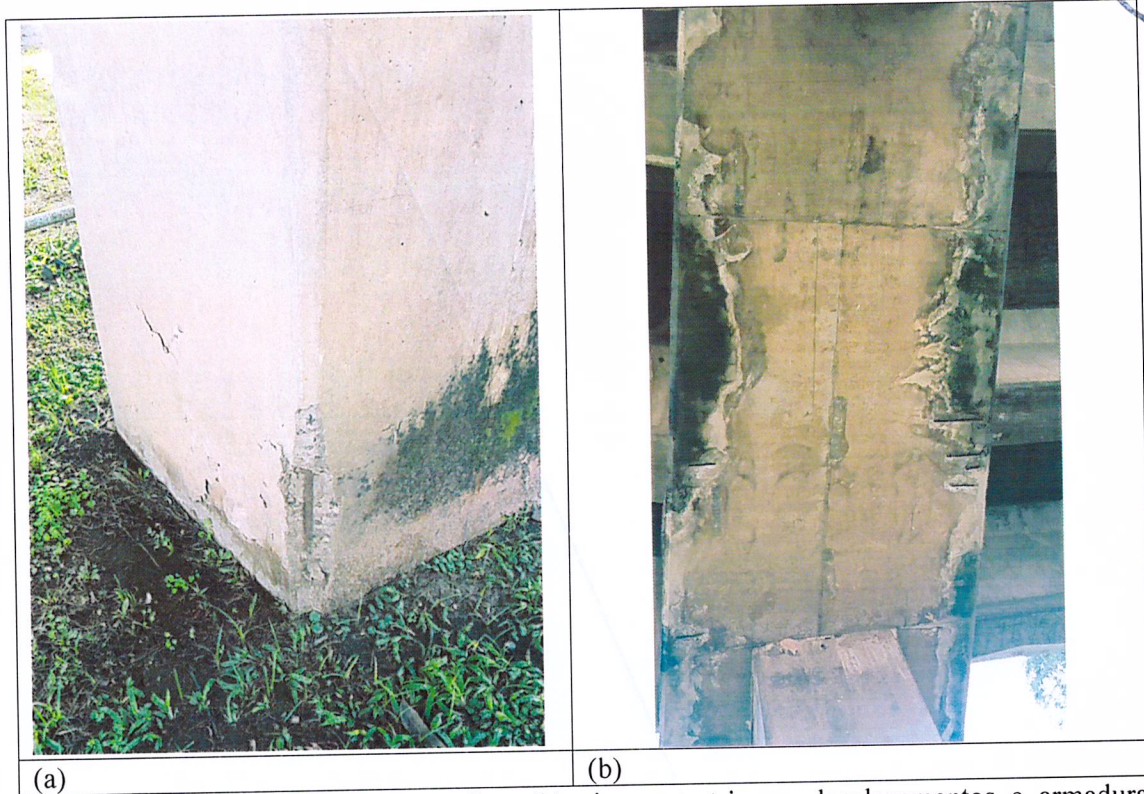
(a) armadura exposta no pilar. (b) viga com trincas, deslocamentos e armaduras expostas oxidadas, presença biológica de limo;
